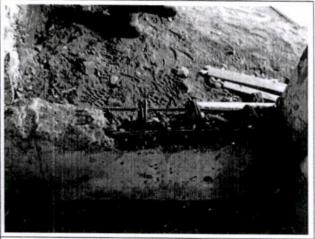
Enfierradura a la vista en viga de fundación, depto. A-102.
